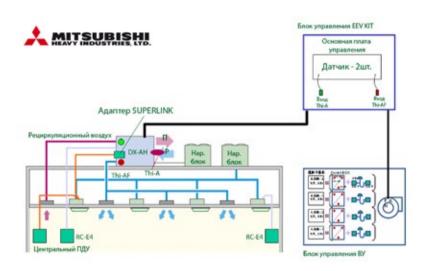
Принципиальная схема использования EEV KIT с вентиляционной установкой
